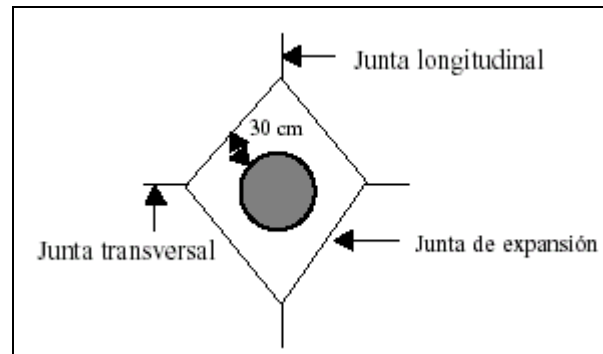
Modulación, Junta y Acero de Refuerzo por Presencia de Estructuras Hidráulicas
